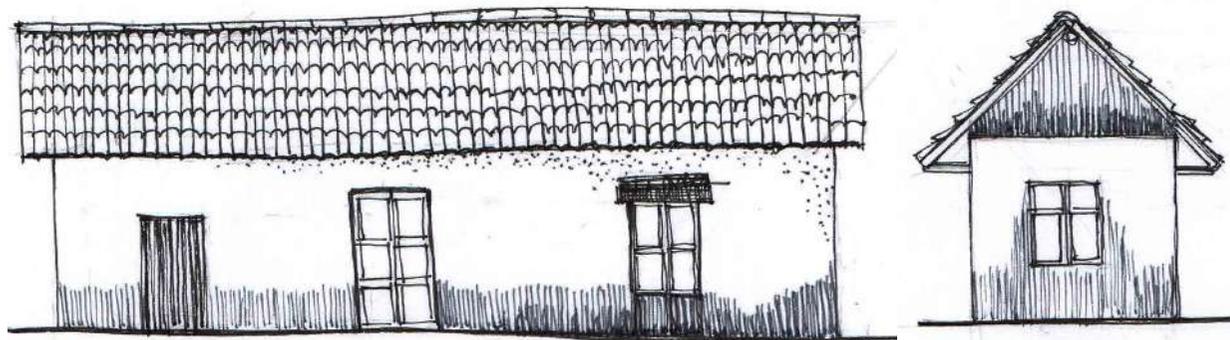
Reconstrucción hipotética de las fachadas de la escuela Nacional.
